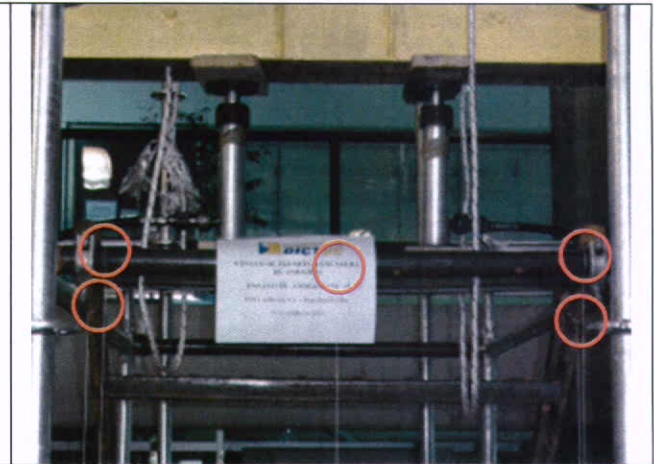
Vista general del montaje del ensayo de corte a peldaño de conexión con travesaño del apoyo superior.
